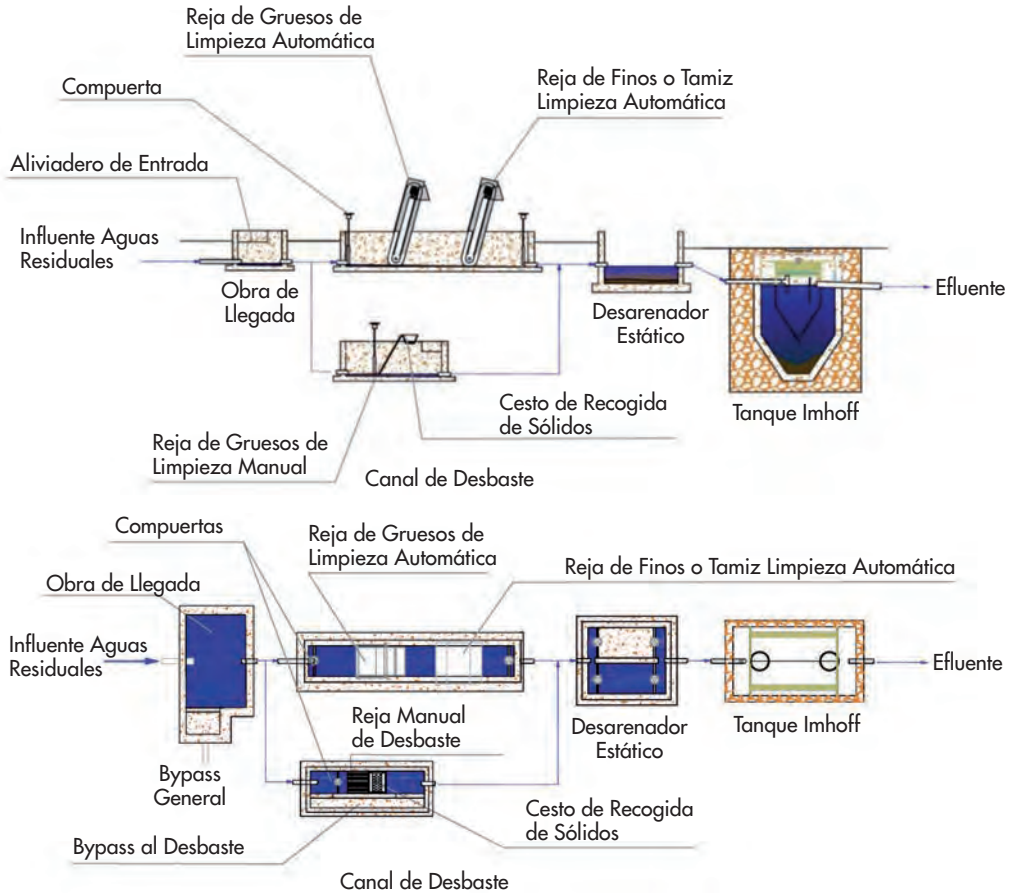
Diagramas de flujo en instalaciones de Tanques Imhoff. Perfil y planta (500-1.000 h-e)
